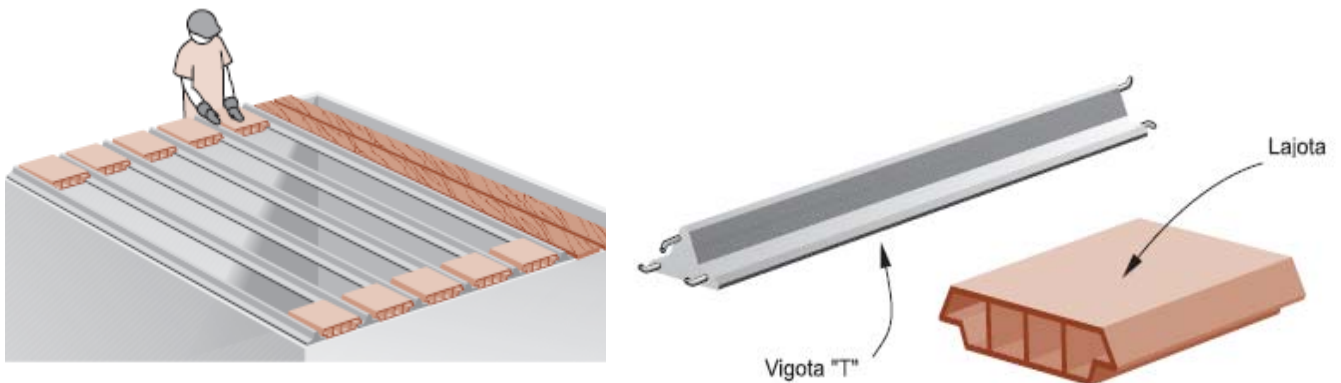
Elementos e montagem de laje pré-fabricada. (Fonte: Mãos a obra – ABCP)
